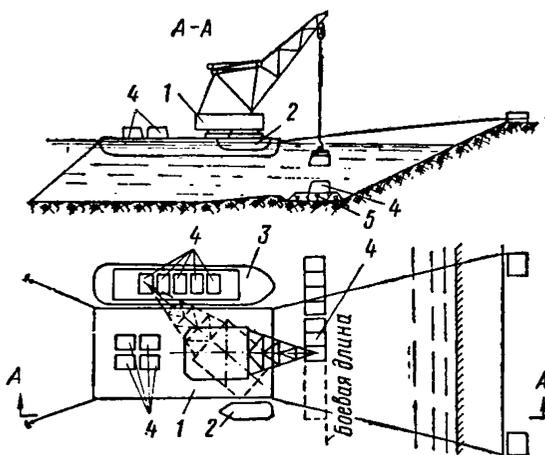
Схема монтажа стенки из правильной массивовой кладки
